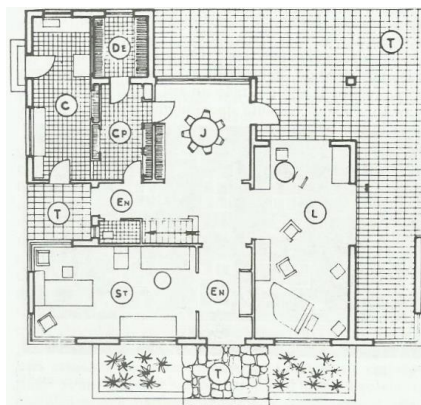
Planta do térreo. Casa do arquiteto. Gregori Warchavchik, 1927-1928, São Paulo, SP
